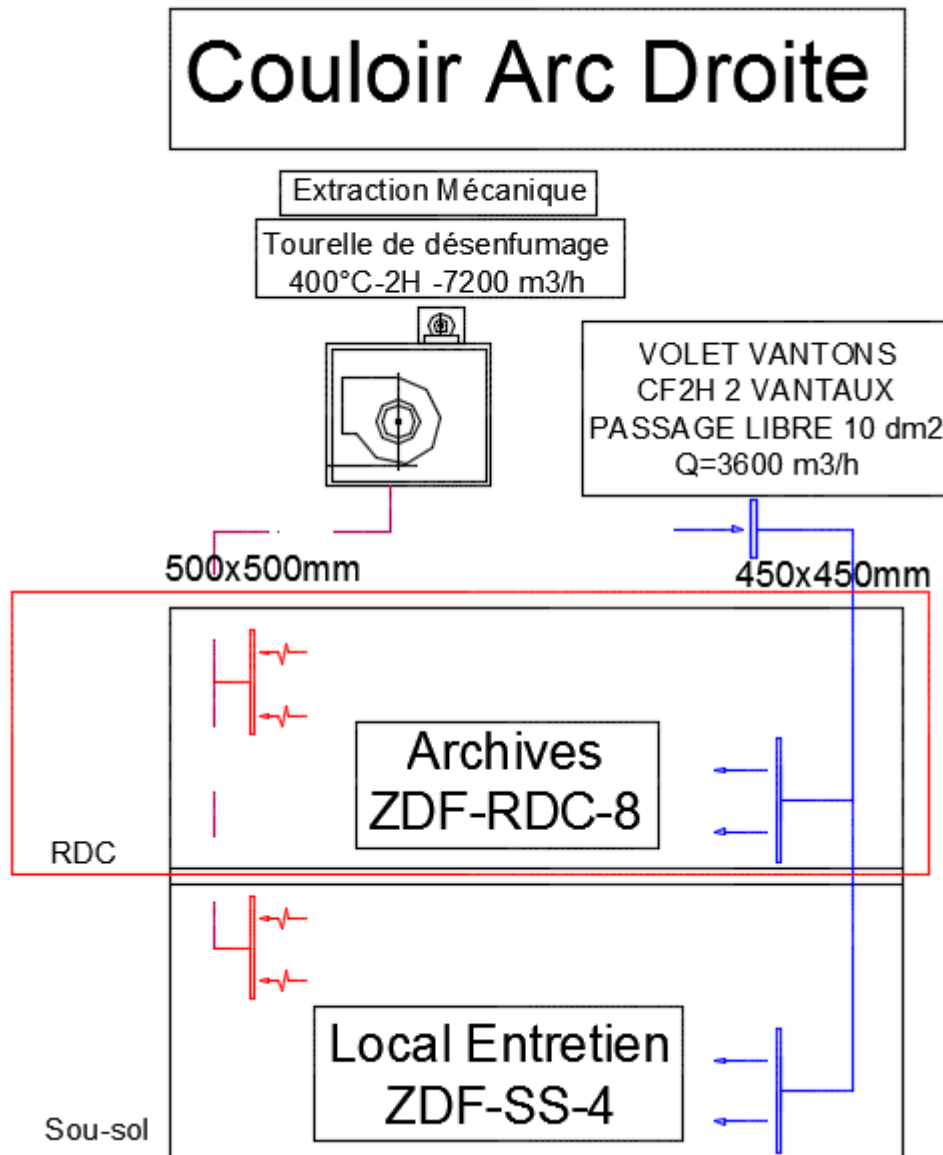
Implantation de système de désenfumage (Couloir arc Droite).
